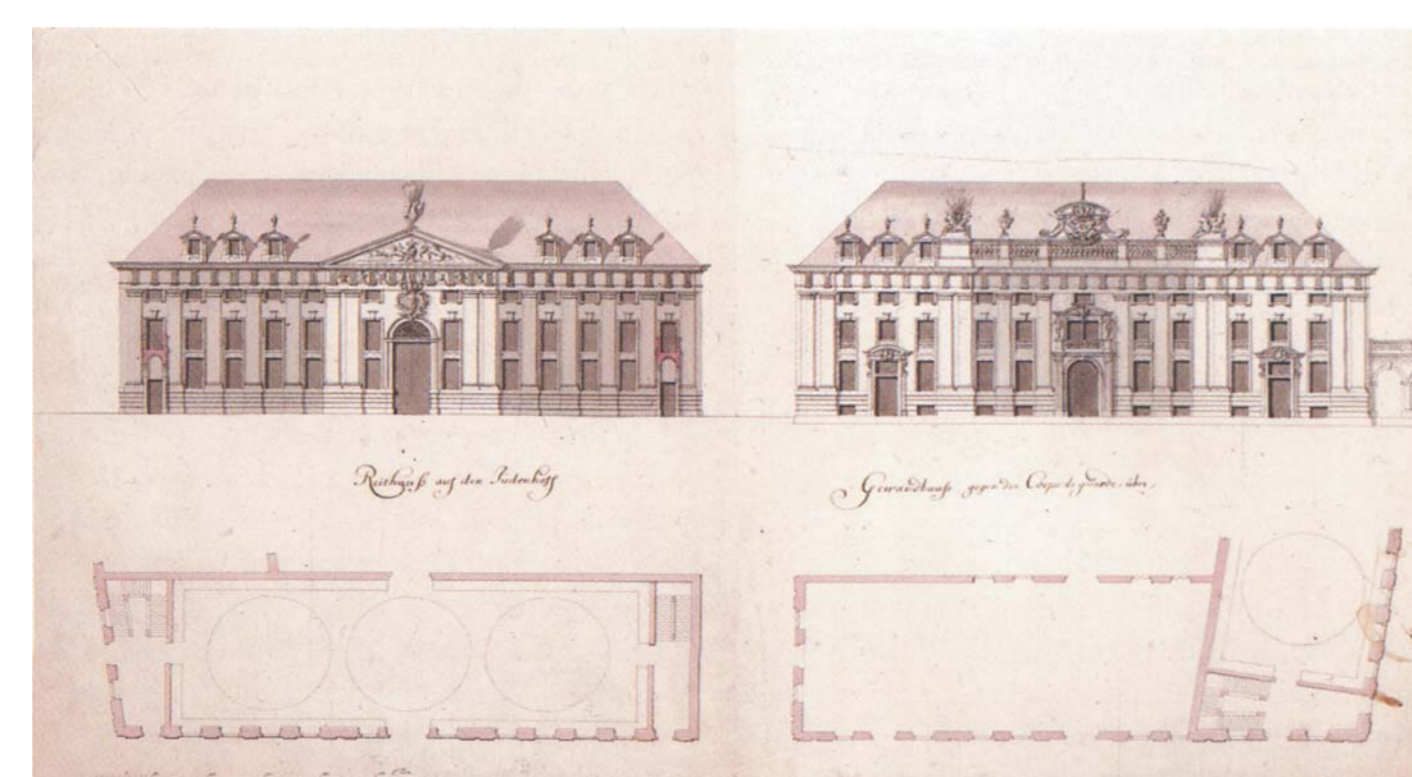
Ansicht und Grundriss des neuen Gewandhauses vom Neumarkt und Ansicht und Grundriss des Reithauses vom Judenhof (J.C. Naumann)
